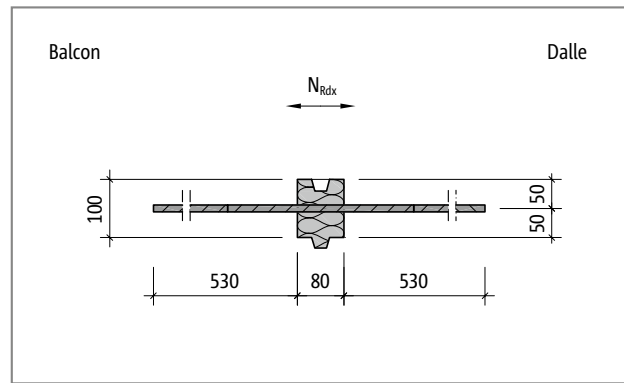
Schöck Isokorb® T Type H-NN2 : Plan de base du produit
